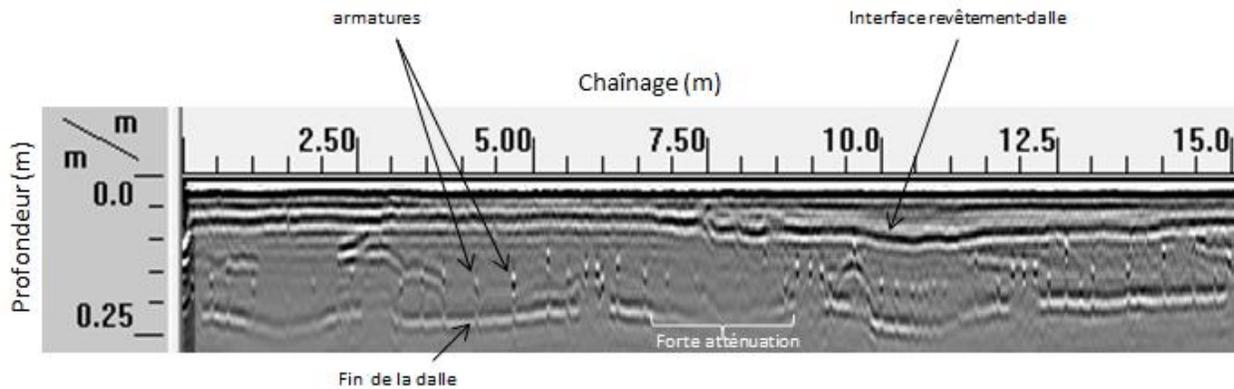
Exemple de relevé Géoradar collecté sur la dalle du stationnement
